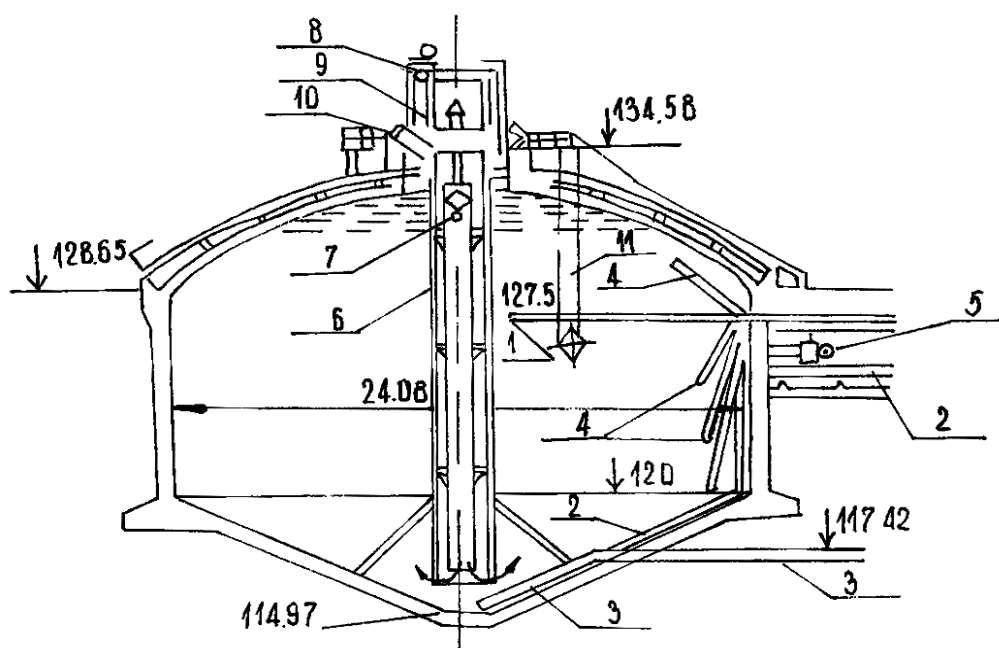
Метантенк: 1 – труба для загрузки осадка; 2 – трубопровод для выгрузки сброженного осадка из конусной части; 3 – трубопровод для опорожнения метантенка; 4 – трубопроводы для удаления иловой воды и выгрузки сброженного осадка с разных горизонтов; 5 – паровой эжектор для подогрева метантенка; 6 – водопроводы; 7 – пропеллерные мешалки; 8 – газопровод; 9 – труба для выпуска газа в атмосферу; 10 – смотровой люк
